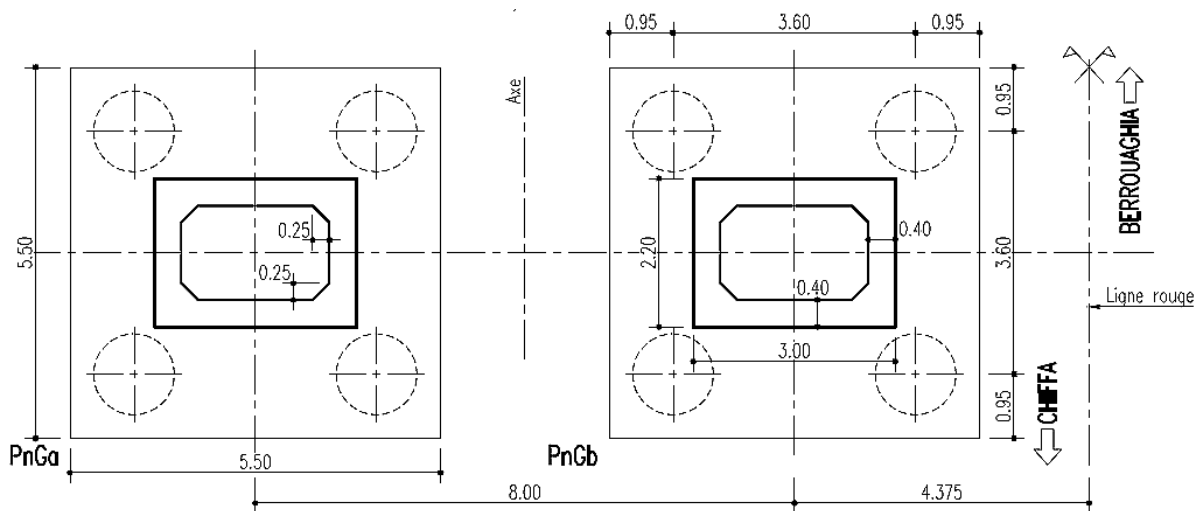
Dimensionnement de fût des piles courtes (une coupe sur semelle de fondation)
